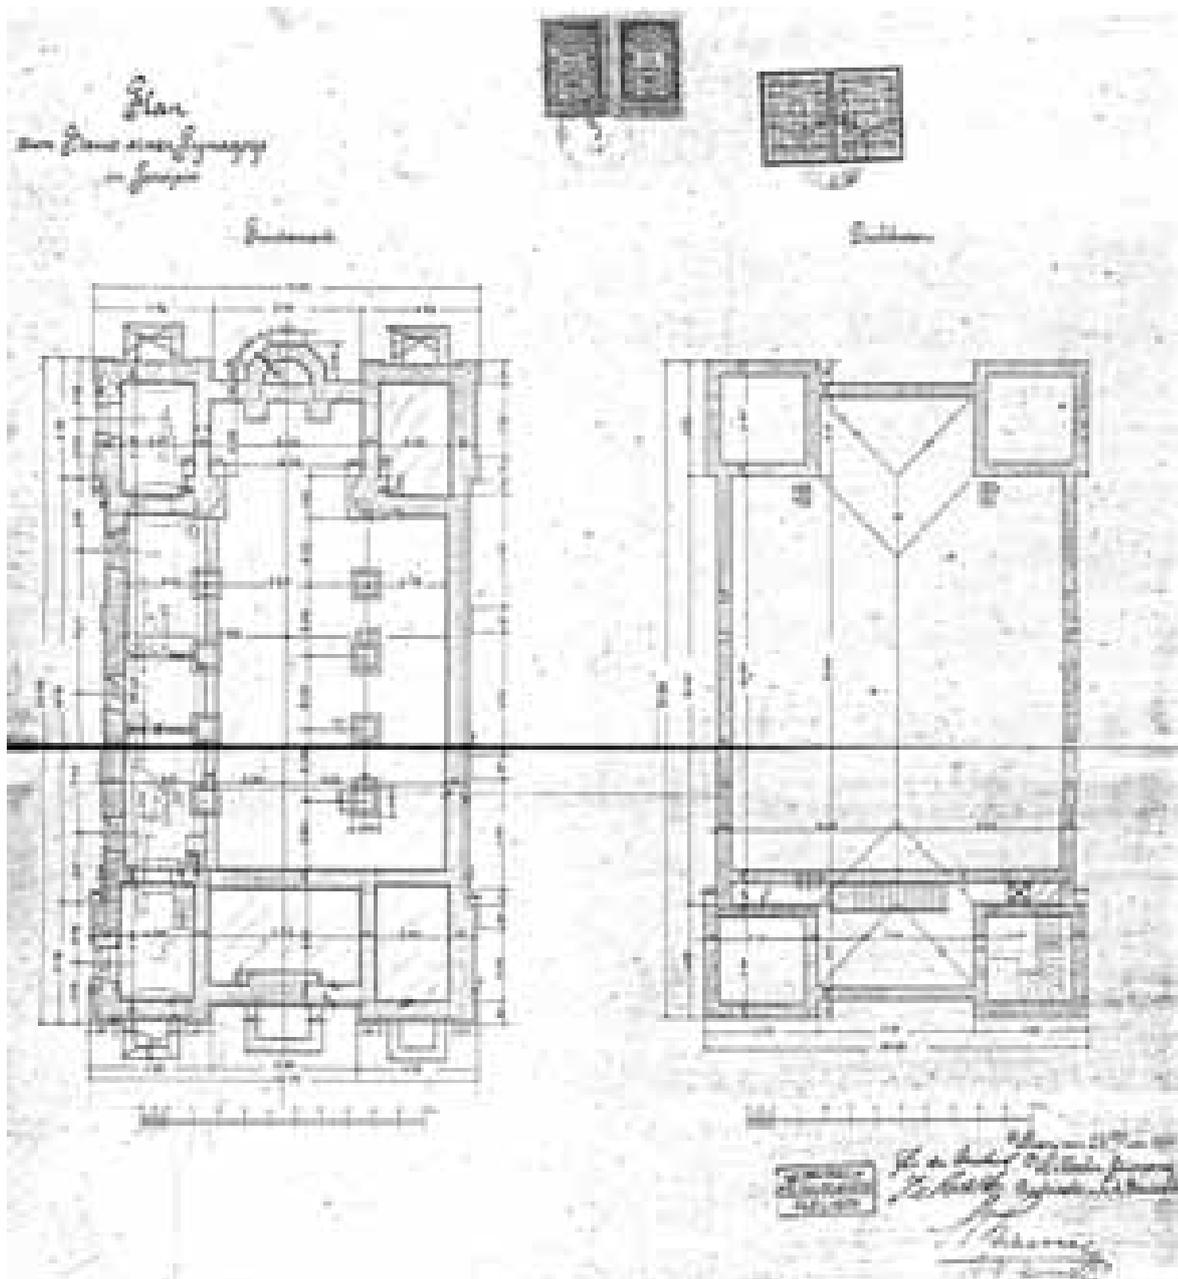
Grundriss des Synagogenprojekts für Sarajevo.
